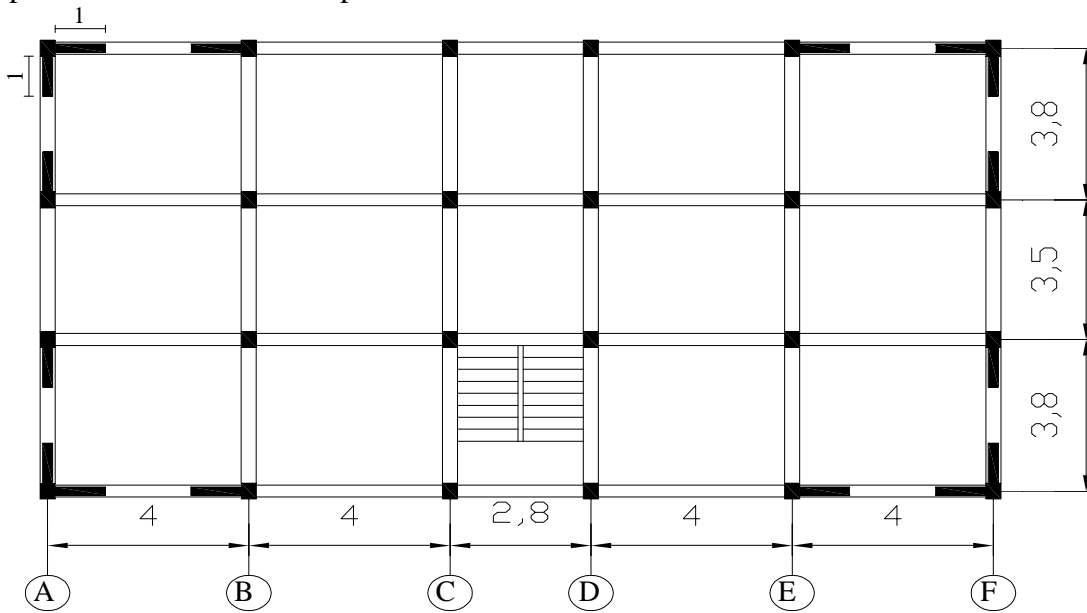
Disposition des voiles de renforcement dans la structure renforcée.
